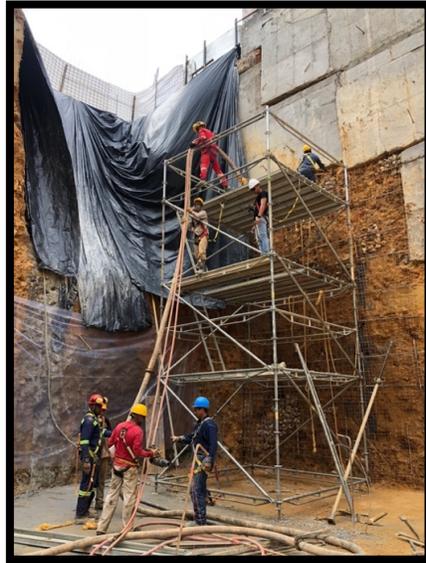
Armadura utilizada para realizar el lanzamiento de concreto.
